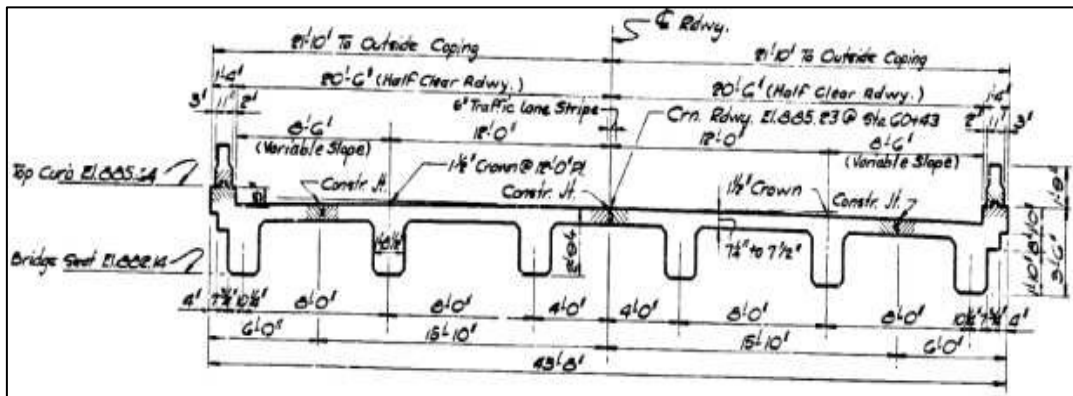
Sección transversal puente No 1 – Planos de diseño.
